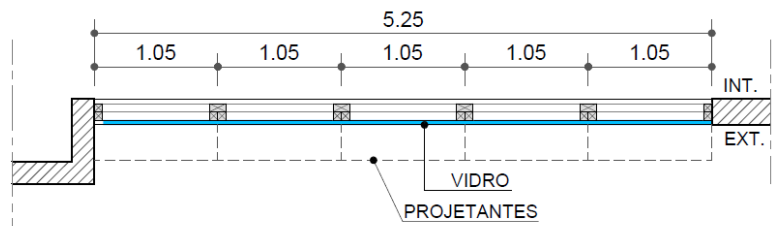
Planta das aberturas de todas as fachadas do edifício de estudo
